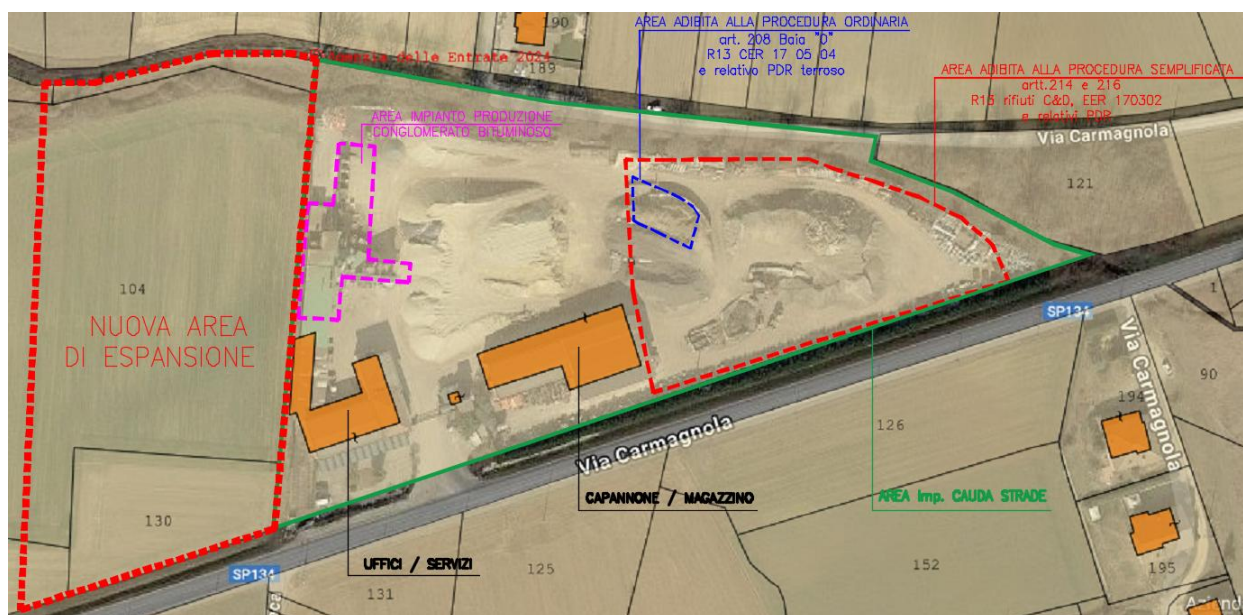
Planimetria generale insediamento CAUDA STRADE_ Pralormo (TO) con indicazione nuova area acquisita ed oggetto di espansione
